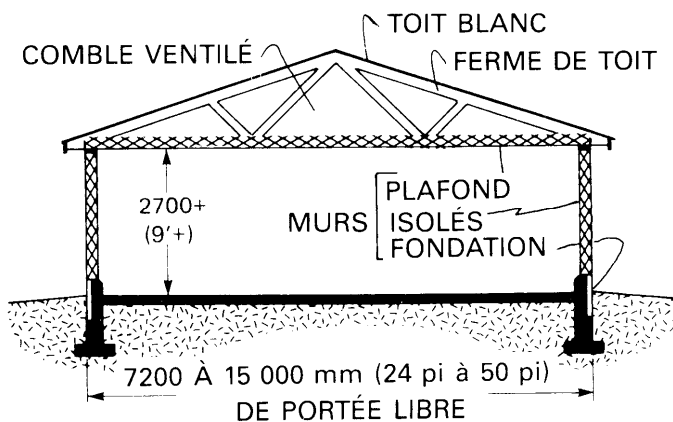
Construction isolée à un étage, à fermes de toit sans support intérieur
